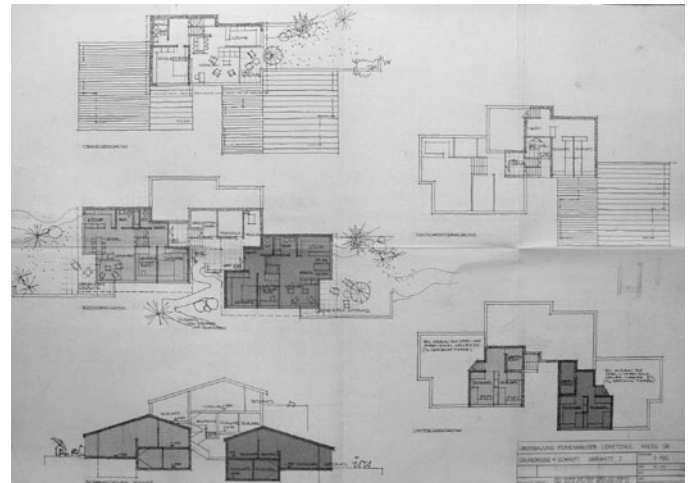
Ferienhausüberbauung Loretzhaus, Avers, Grundrisse, Schnitte und Südfassaden Variante I, Richard Brosi, undatiert.
